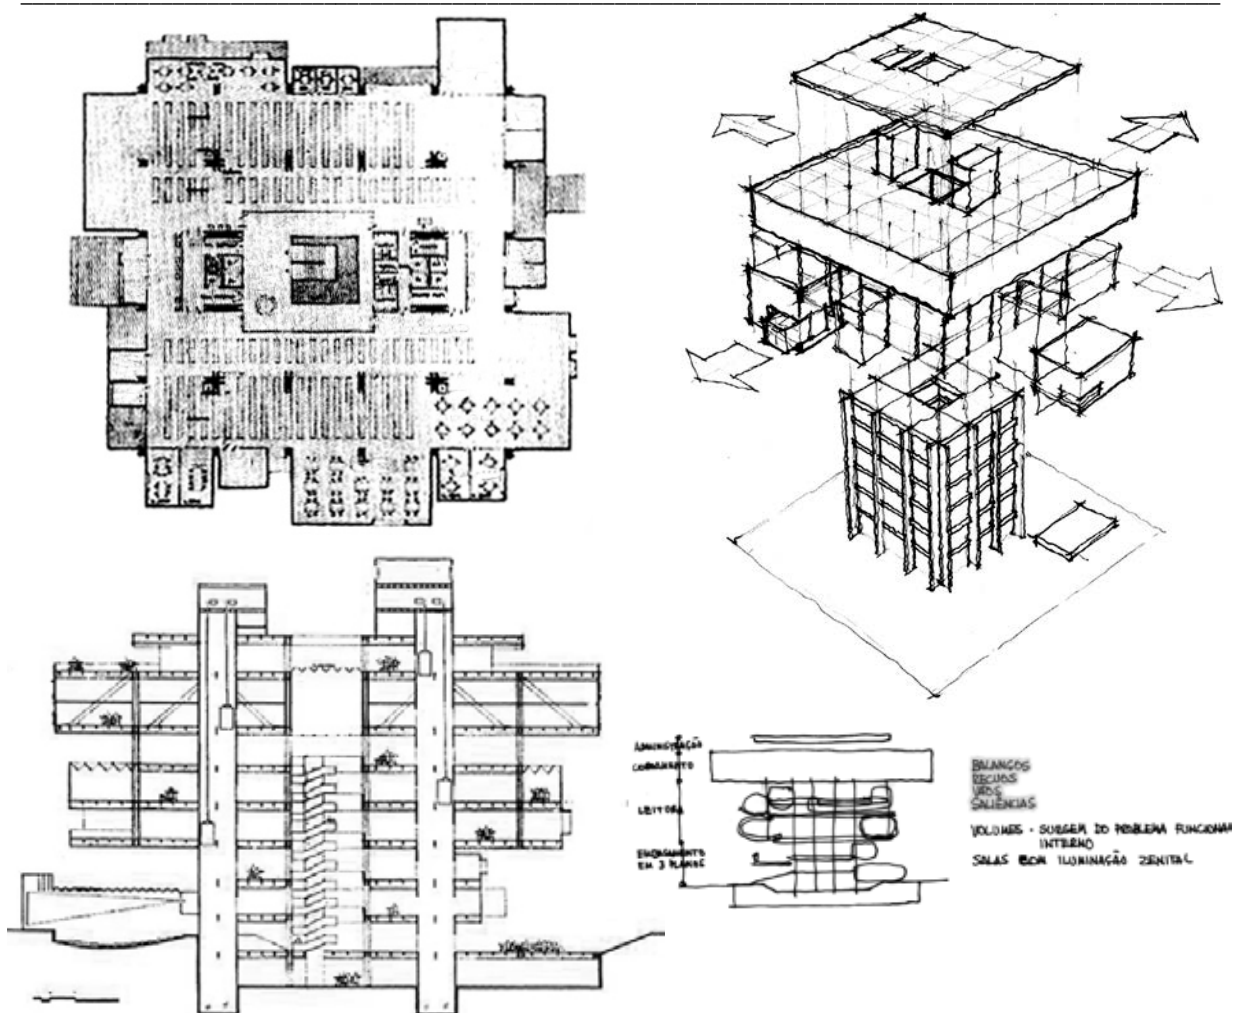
3º lugar (Roberto Gandolfi, José Sanchotene e Abrão Assad) planta pavimentos intermediários;
